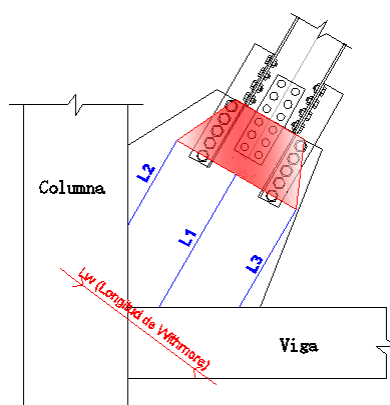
Placa Gusset, y ancho efectivo Whitmore
